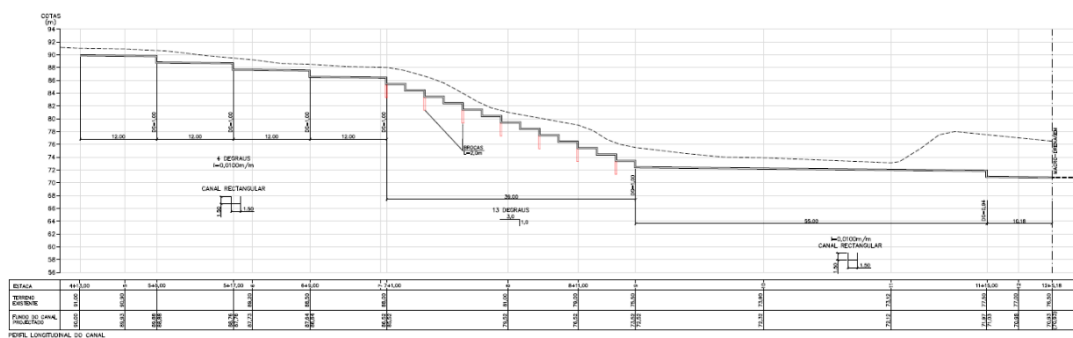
Secção longitudinal do canal de betão armado com sistema de fixação ao terreno, projeto de execução (BDM, 2017)
